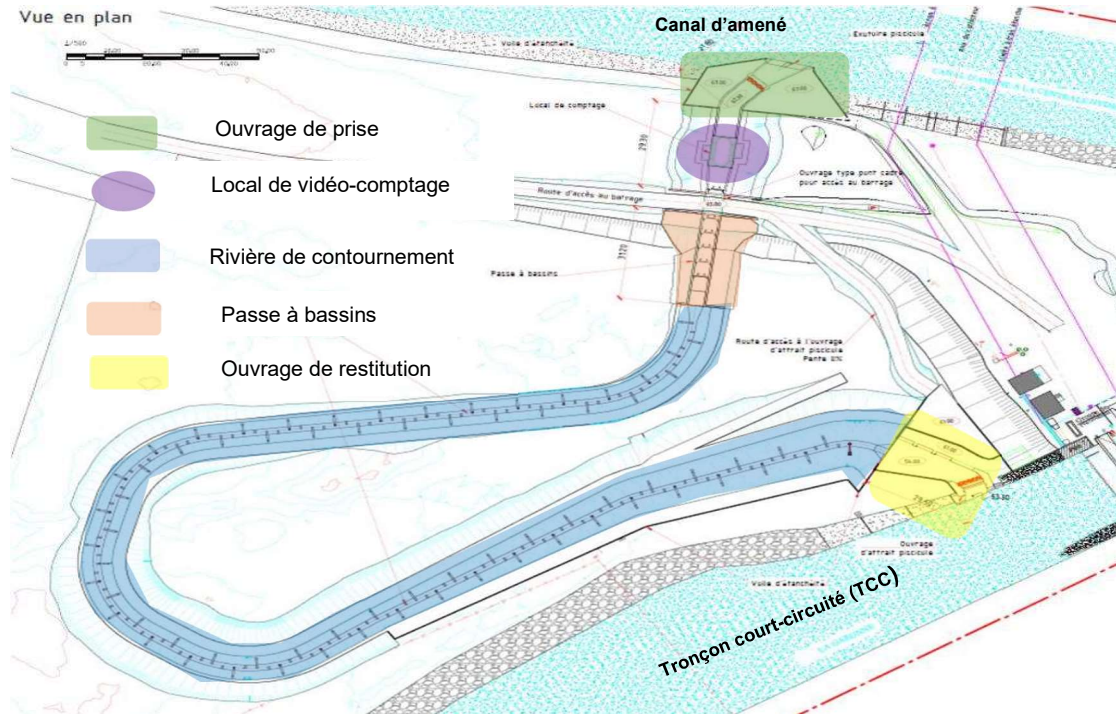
Plan technique du dispositif de franchissement mis en place (EDF, Thomas PIQUET, 2022)
